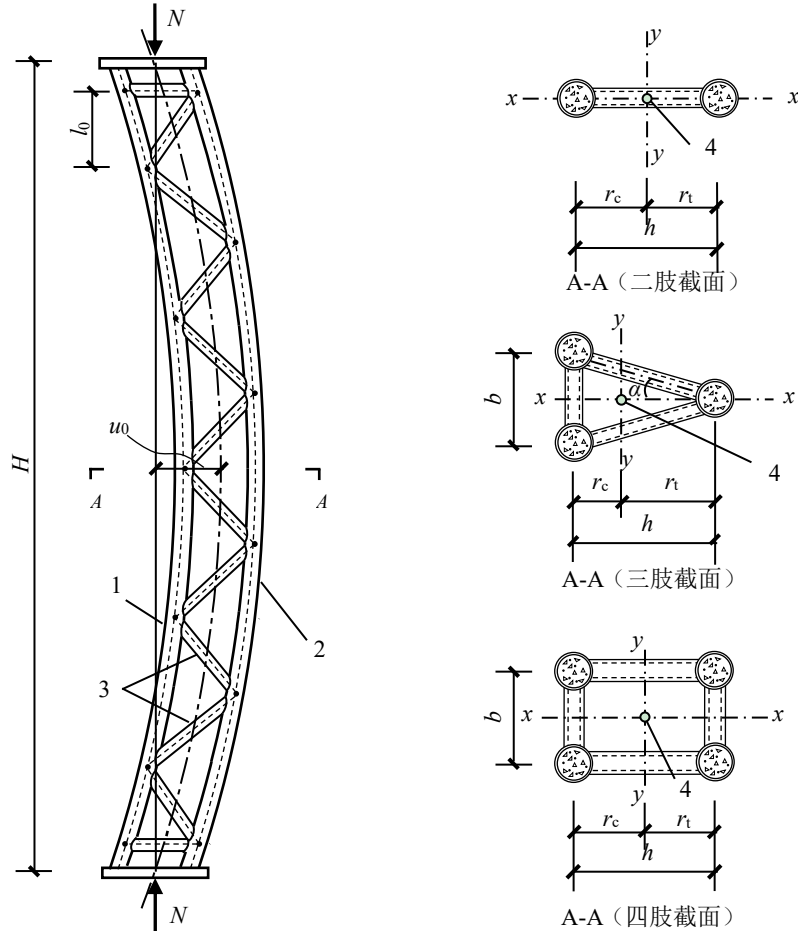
曲线形桁式钢管混凝土压弯构件
